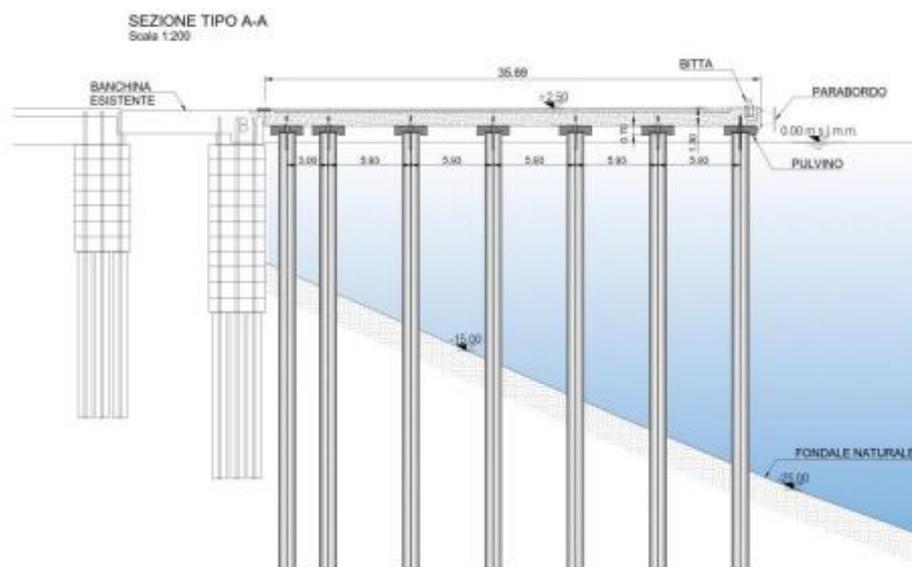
Sezione tipo A – A – Stato di progetto ampliamento della banchina esistente
